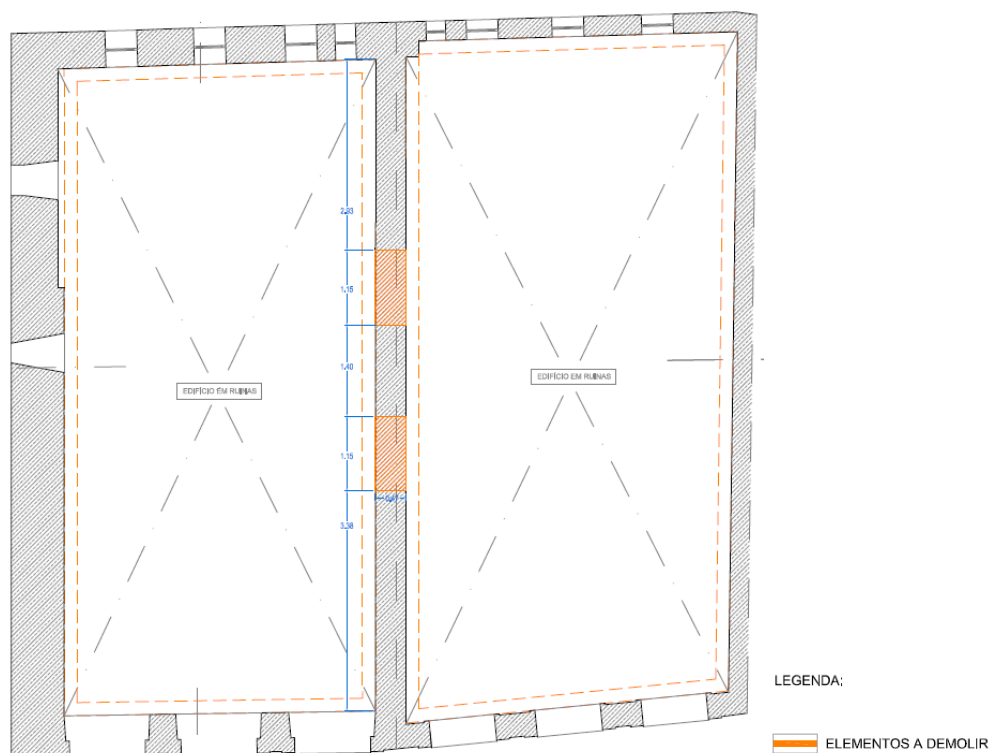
Planta do 1º piso com elementos a demolir - Fonte: Desenhos de Arquitetura da Operação E2 - Projeto 9
